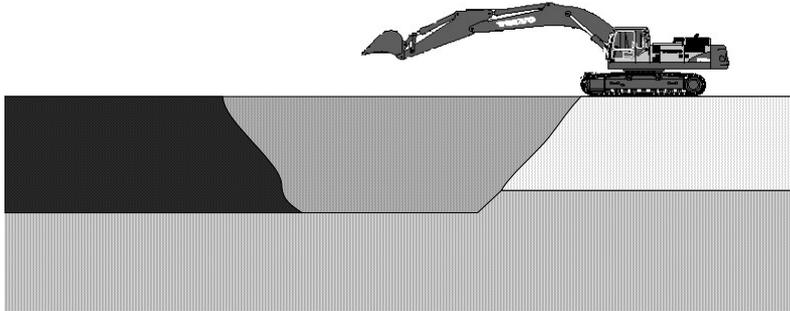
Herstellung einer Dichtschlitzwand durch kontinuierliches Ausheben [5]
